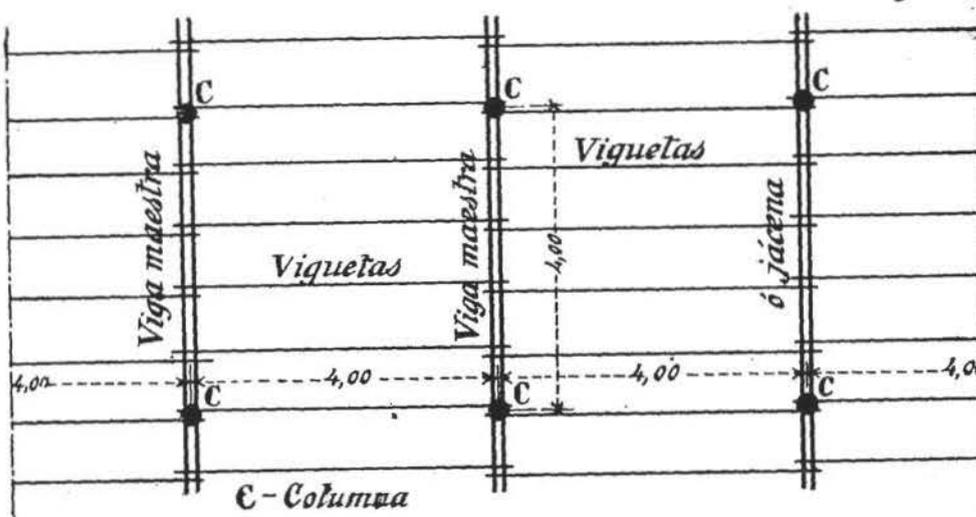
Entramado del techo de un almacén (columnas, vigas maestras y viguetas).
